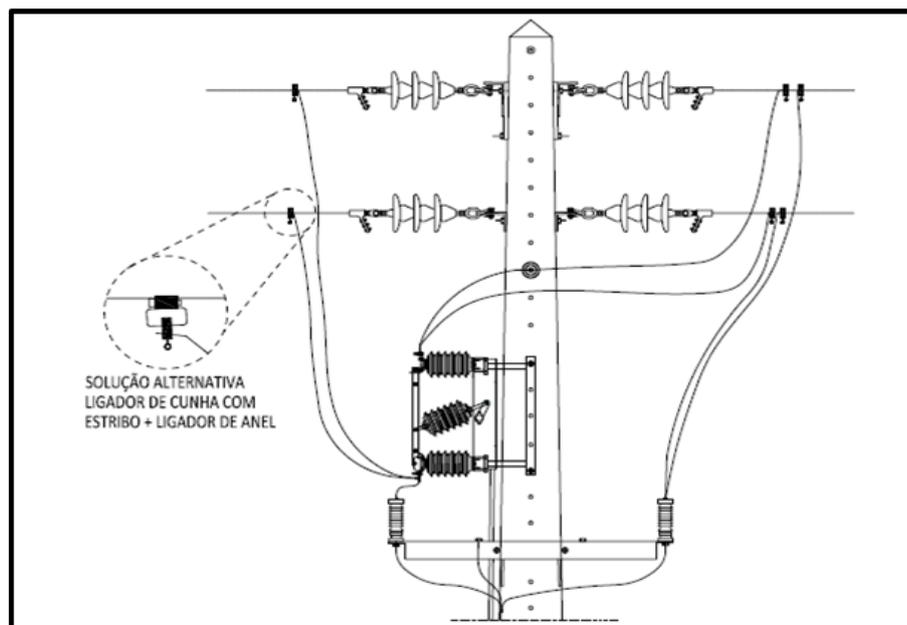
Montagem de seccionador em apoio de alinhamento/ângulo com armação em triângulo
